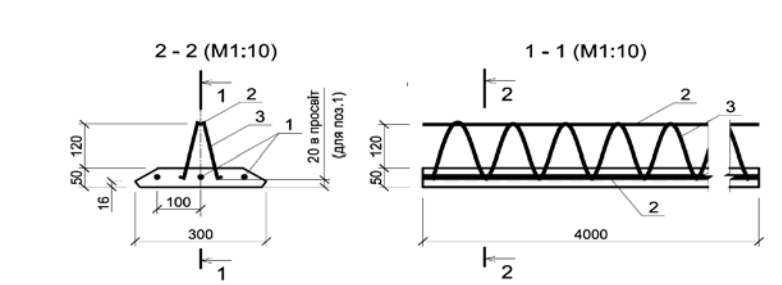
Конструкція плити опалубки ПО–4
